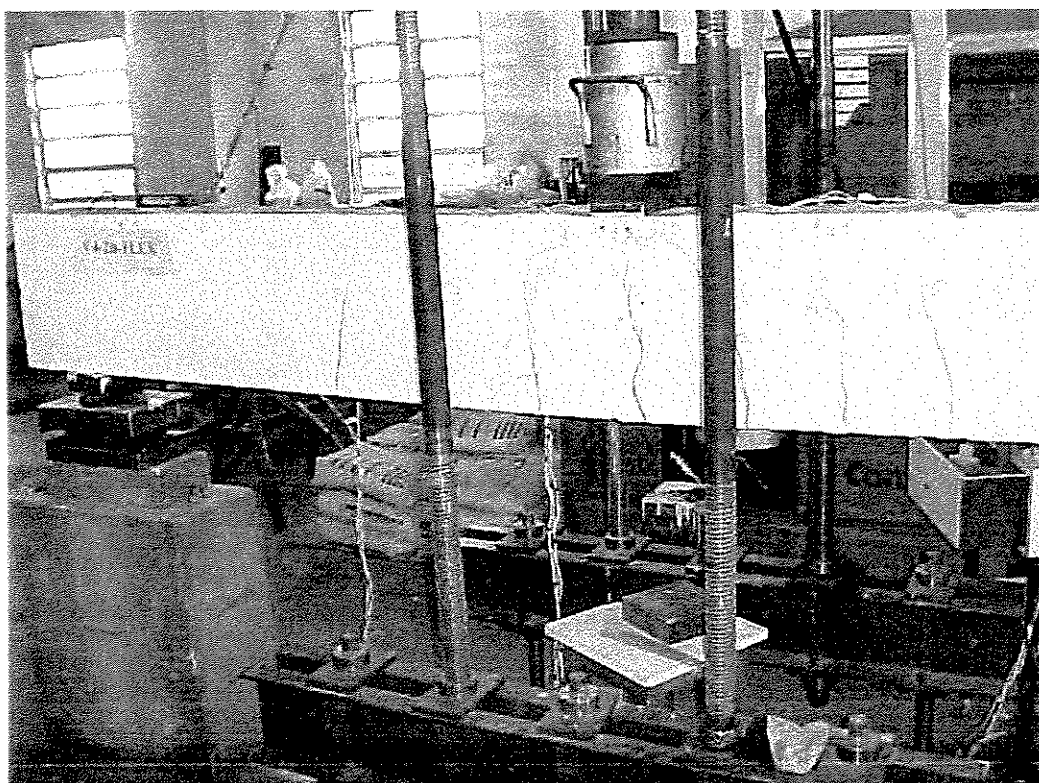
VIGA 2BL-FL APÓS ENSAIO
